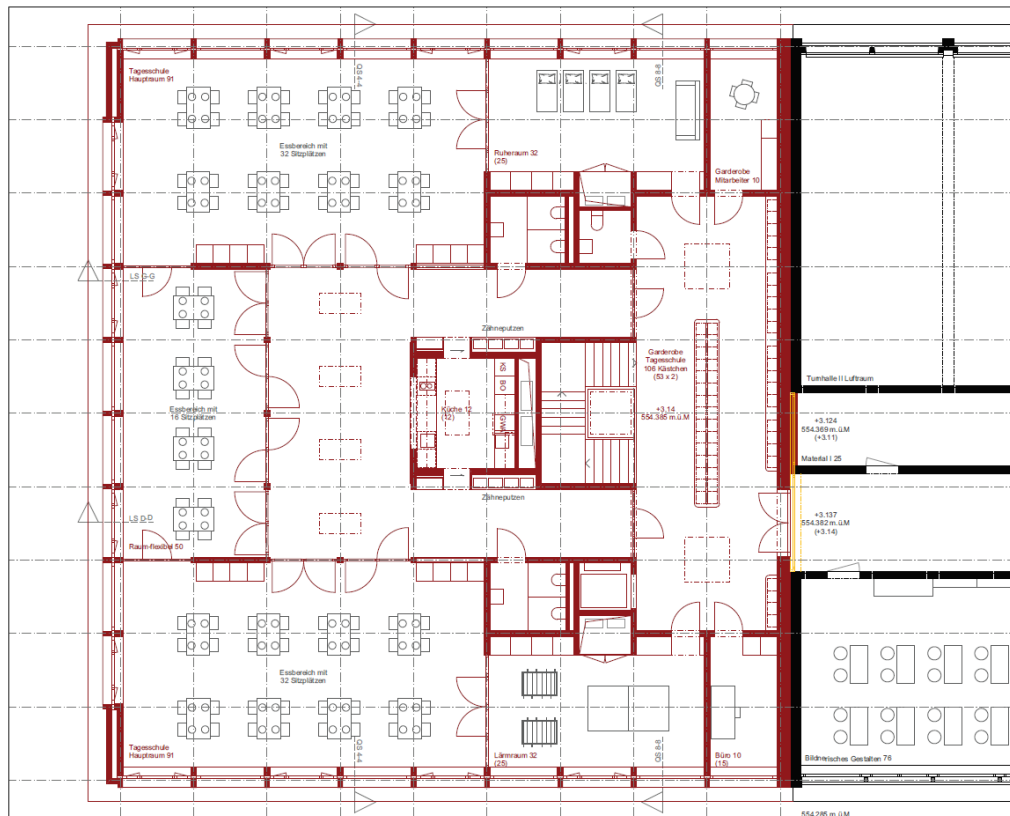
Grundriss Obergeschoss mit Tagesschule
